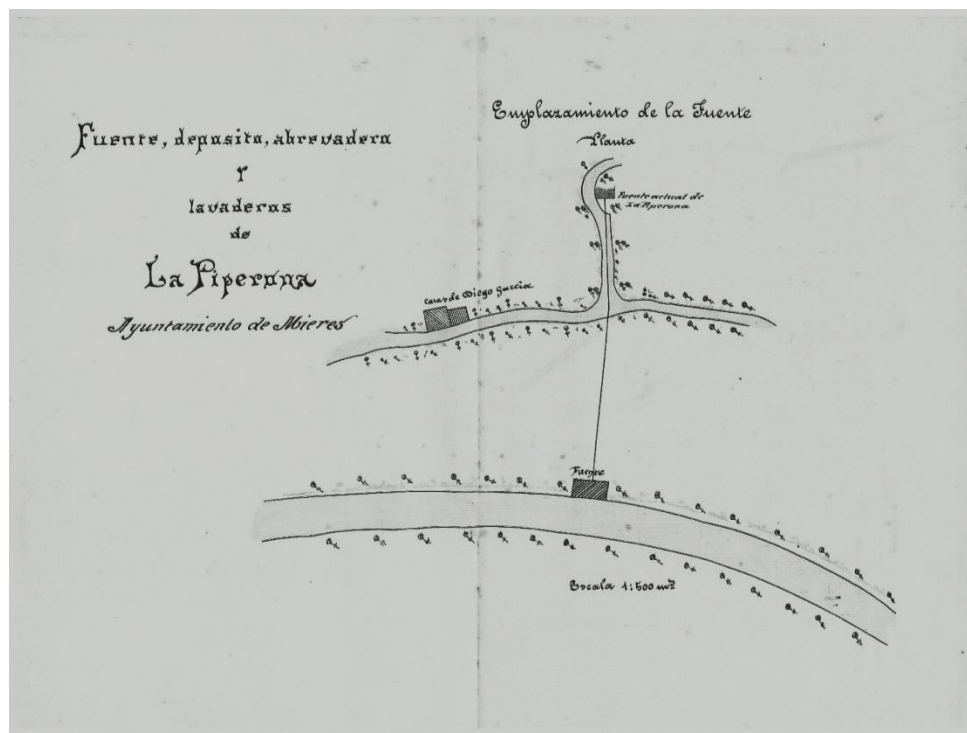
Proyecto de Fuente, depósito y lavadero de La Piperona. Emplazamiento, alzado. Ayuntamiento de Mieres. 1899. Archivo Municipal de Mieres.
